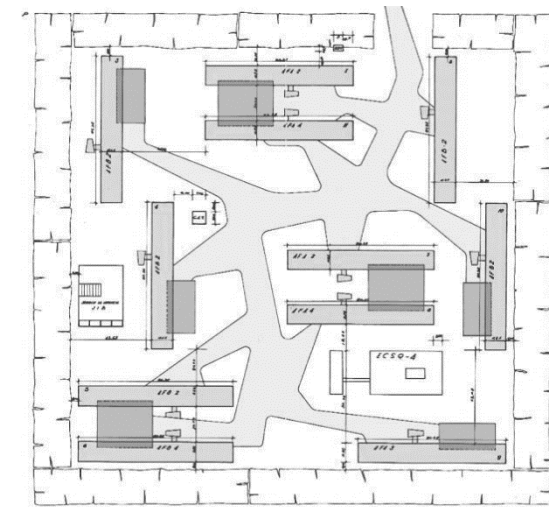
Proposta para implantação e arruamentos da SQS 108. Fonte: Wen (2011)
